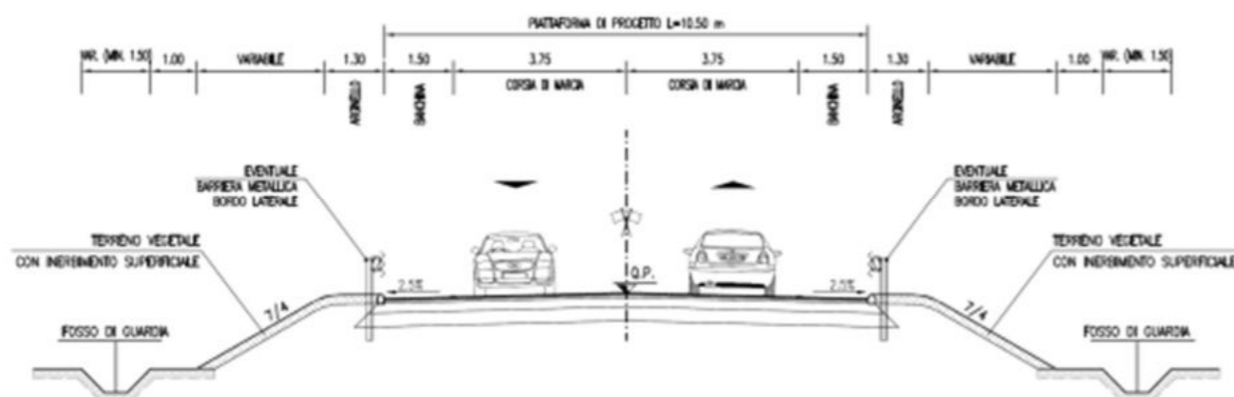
Sezione tipo rampa di svincolo bidirezionale
